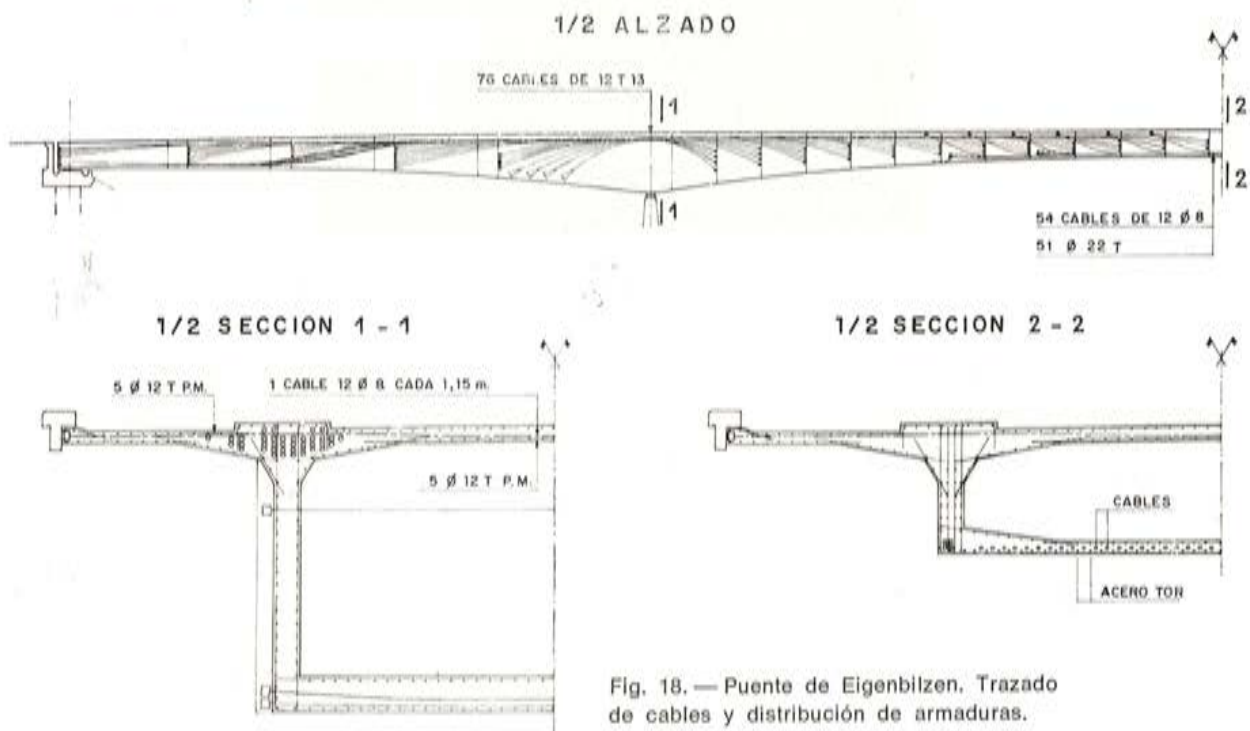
Puente de Eigenbilzen. Trazado de cables y distribución de armaduras.
